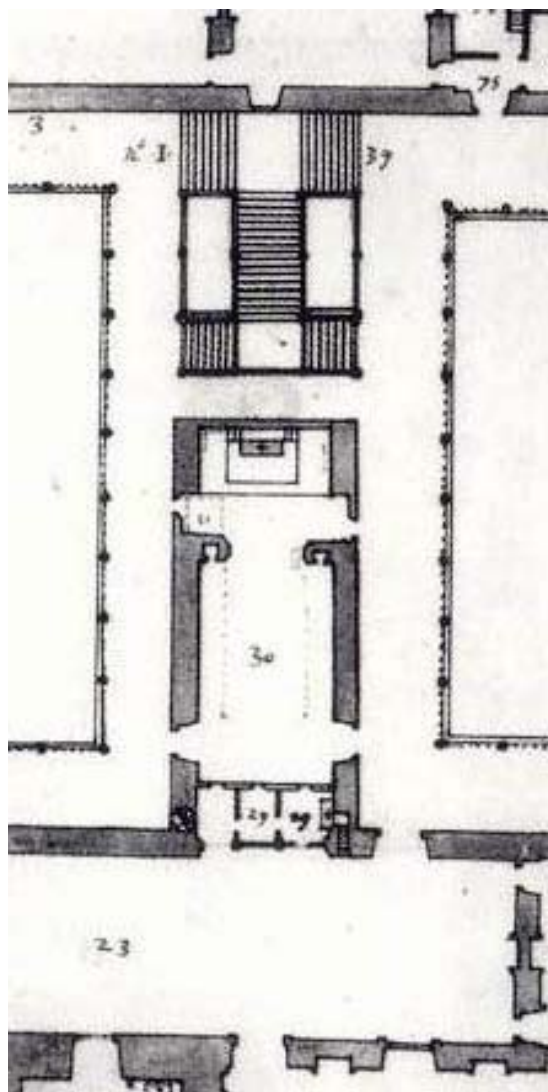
Capilla en la Planta Principal del Alcázar. Según Plano de Juan Gómez de Mora 1626. BV Vaticano
